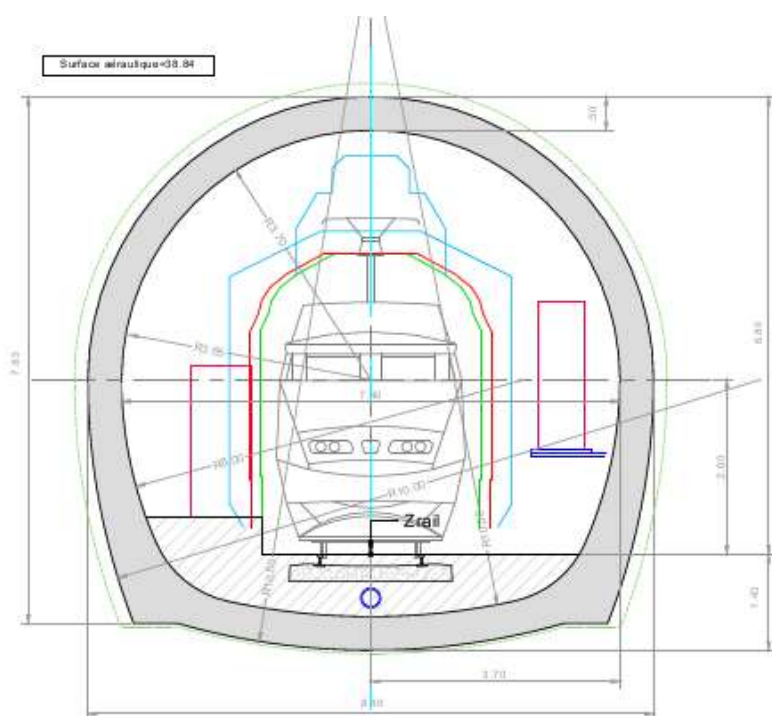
Profil en travers type du tunnel (EGIS, 2021)
